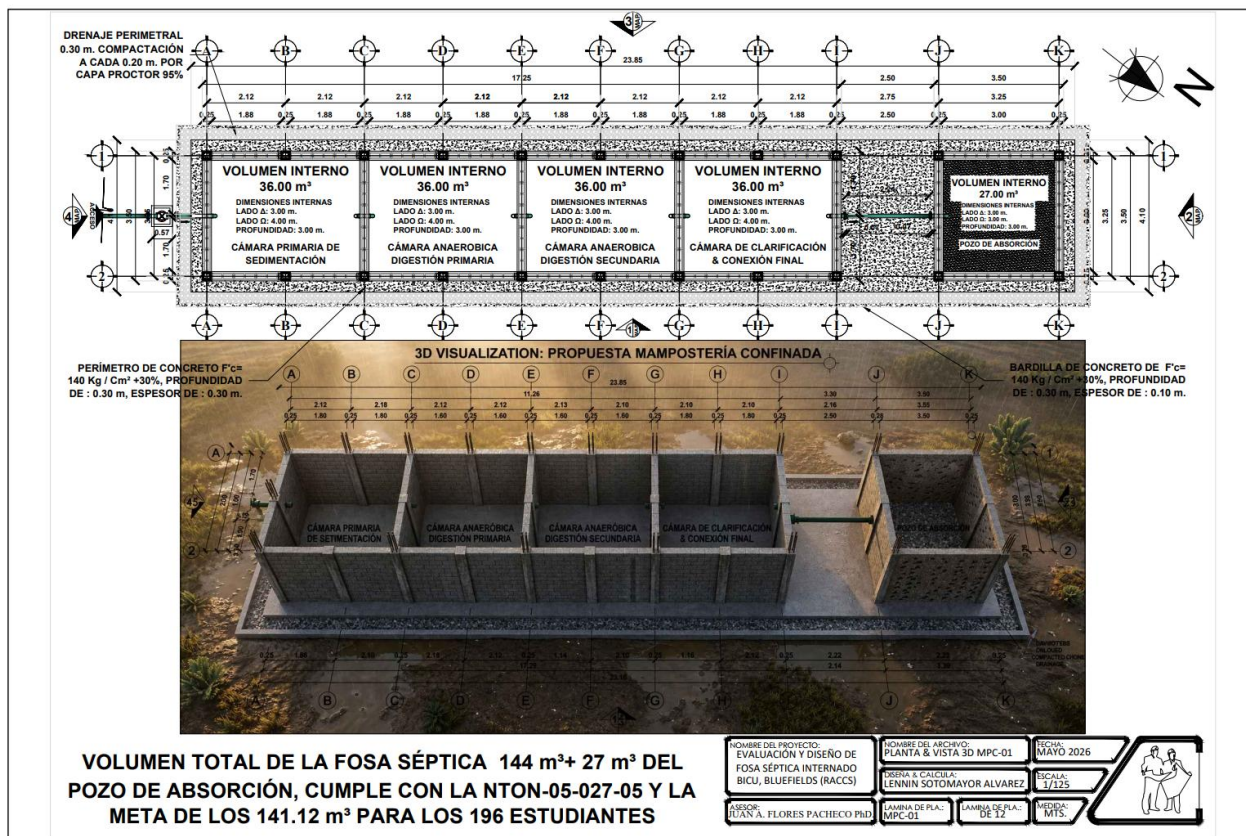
Planta arquitectónica y visualización 3D de la alternativa en mampostería confinada para el sistema séptico del internado de BICU, Bluefields.
